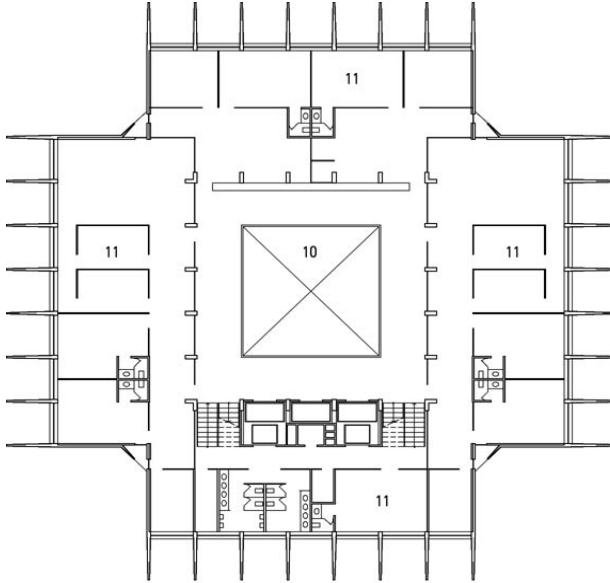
Palácio da Justiça. Projeto: Saraiva, Petracco e Bussab [1968] Planta baixa pavimento tipo (com divisórias). [Fonte: Arquivos do arquiteto, 2008].
